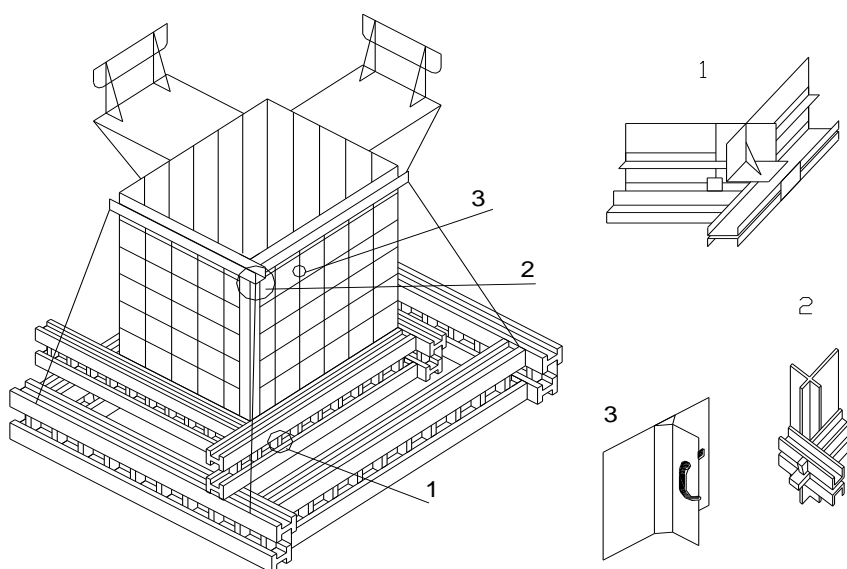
Общий вид опалубки столбчатого фундамента из инвентарных щитов.
